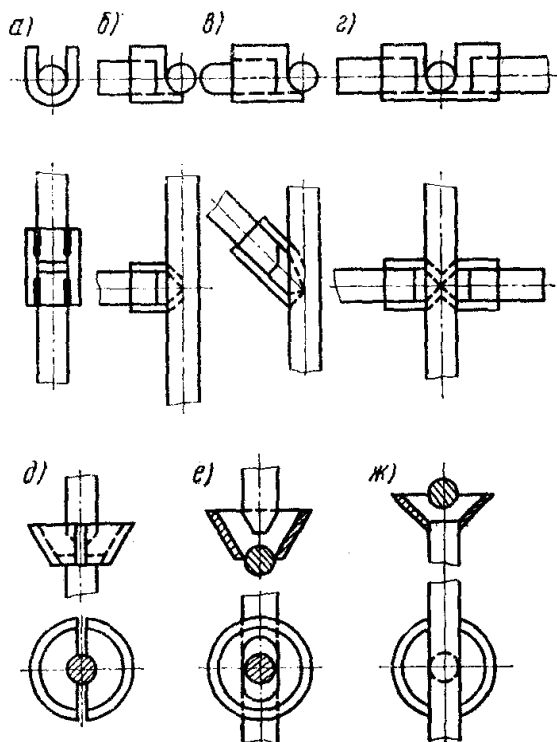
Сварные соединения арматуры, выполняемые ваннным способом
